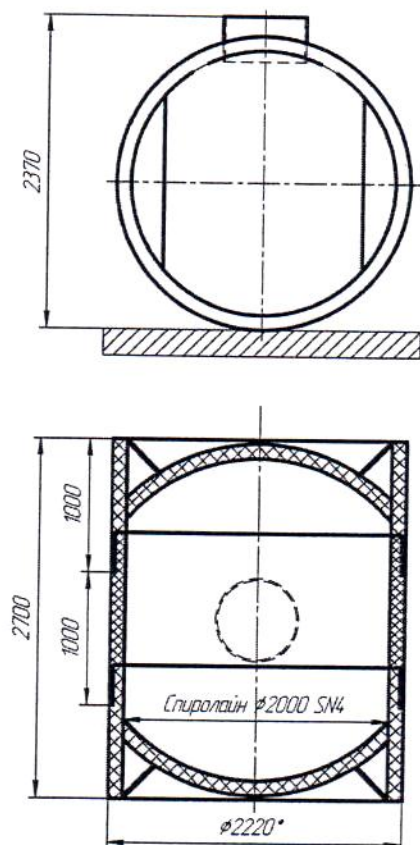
Конструкция образца №2 для динамических испытаний
